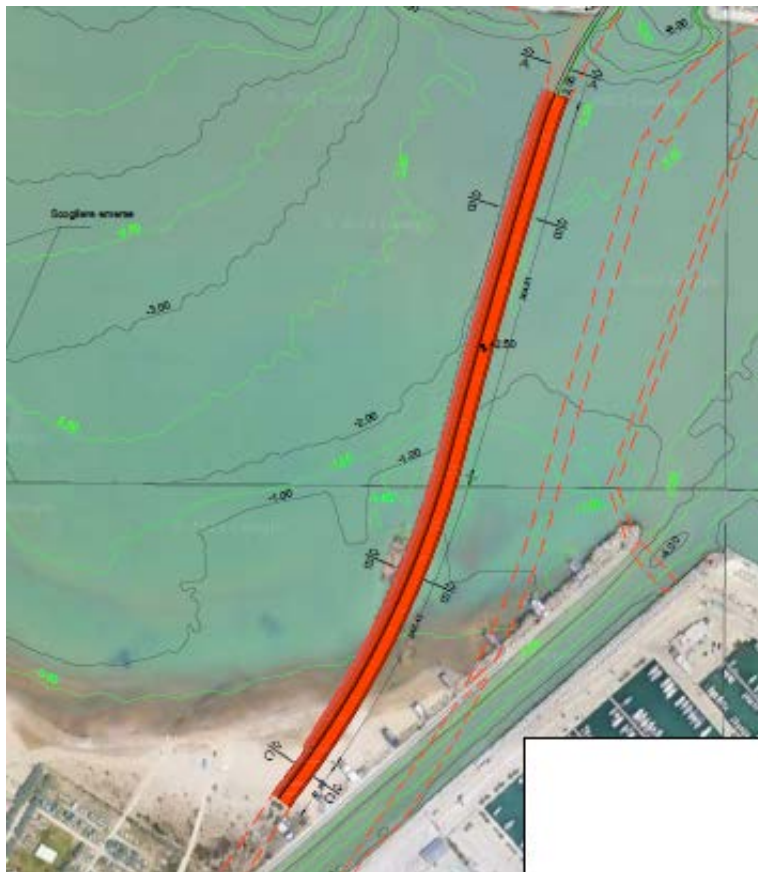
Planimetria con inquadramento delle sezioni del Molo Nord
